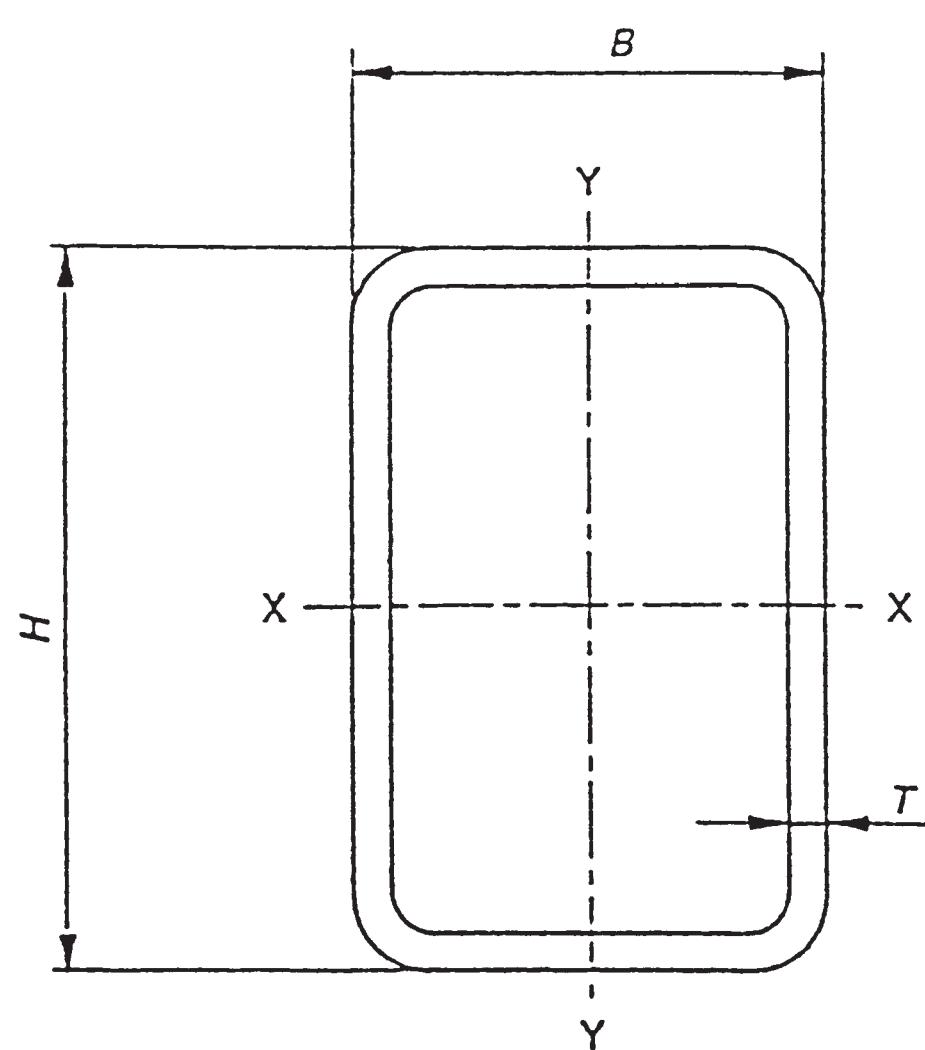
Hohlprofil mit rechteckigem Querschnitt
